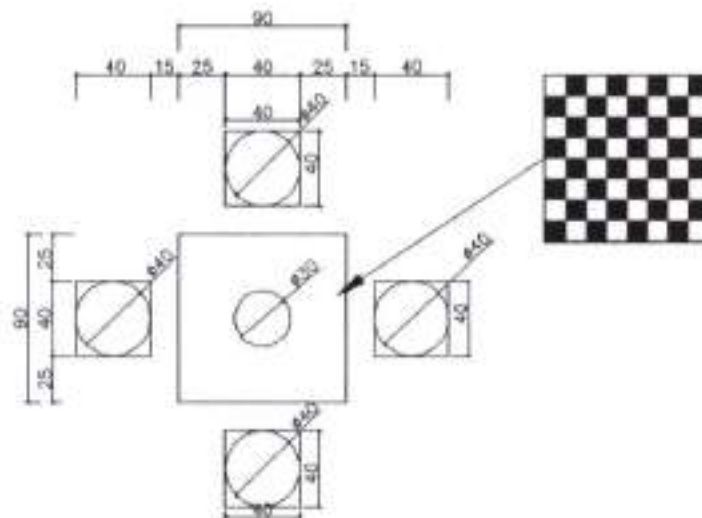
Ilustração da mesa de concreto com tabuleiros e bancos.
